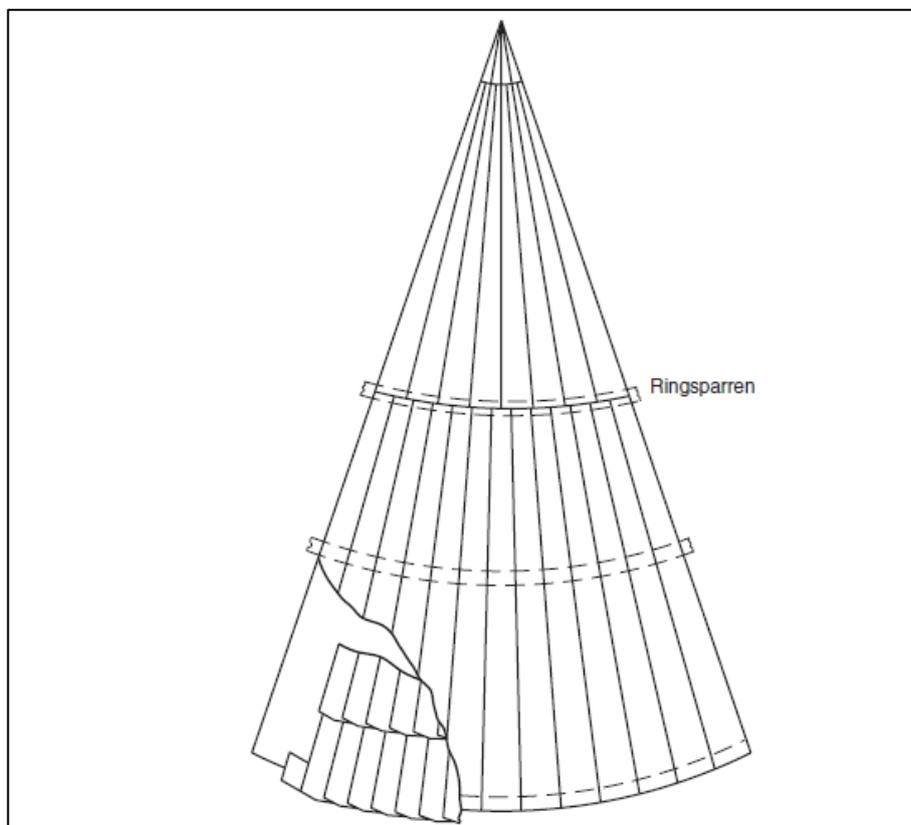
Runddeckung mit Steinschindel außer Verband, erstes Deckgebirde auf Unterlegern (zweifacher Fuß)
